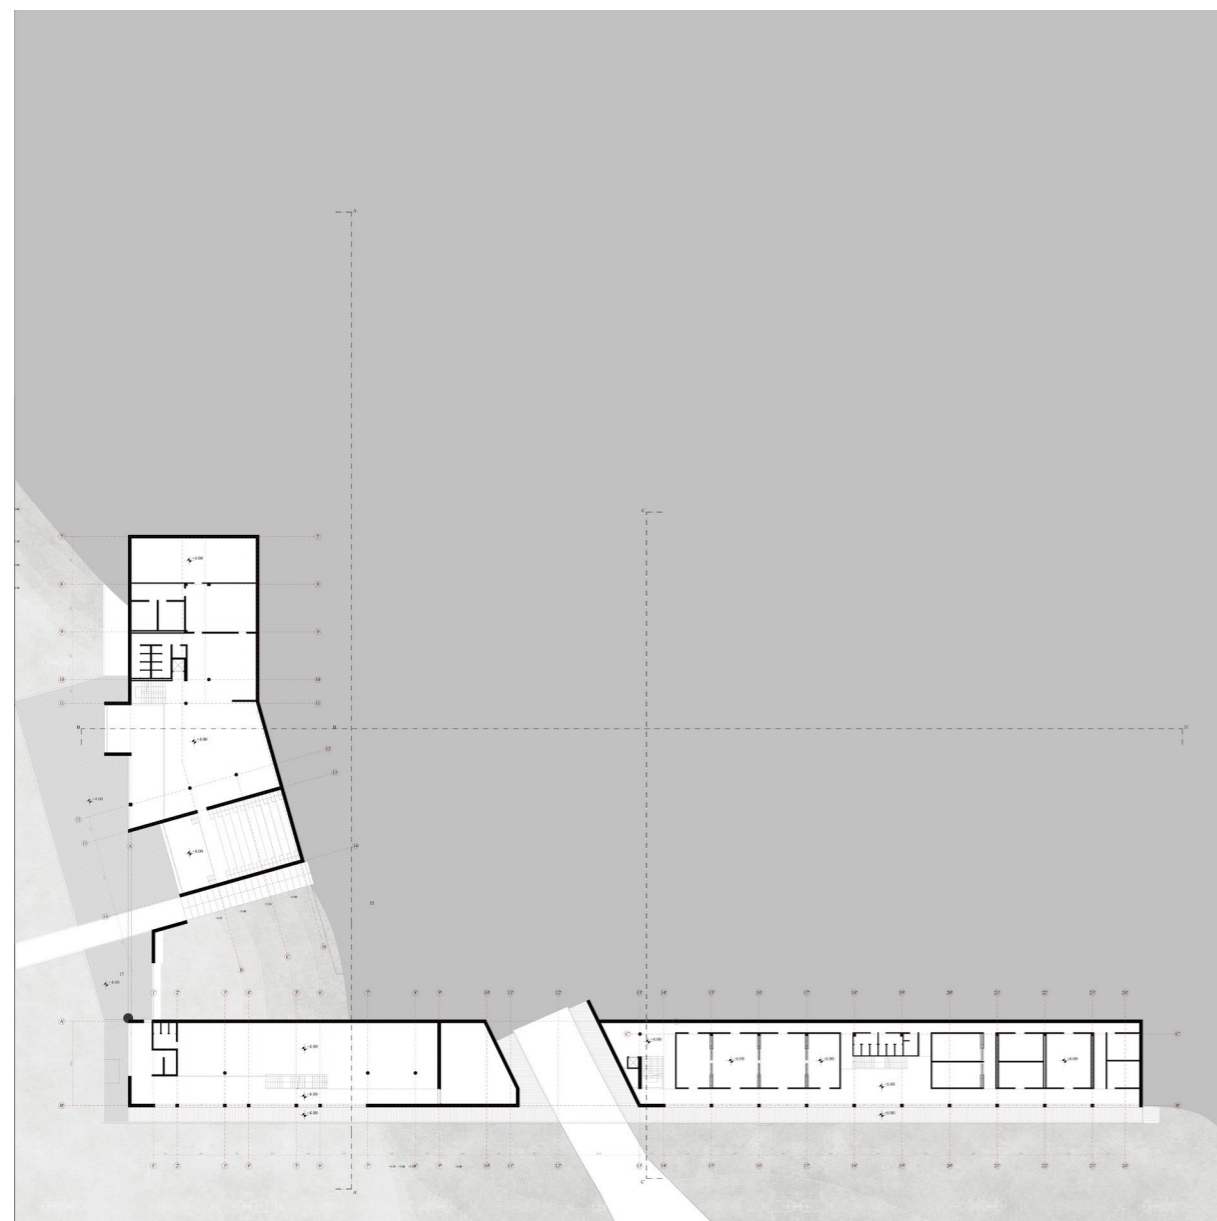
Pianta di progetto, quota di sezione +6.50 metri
